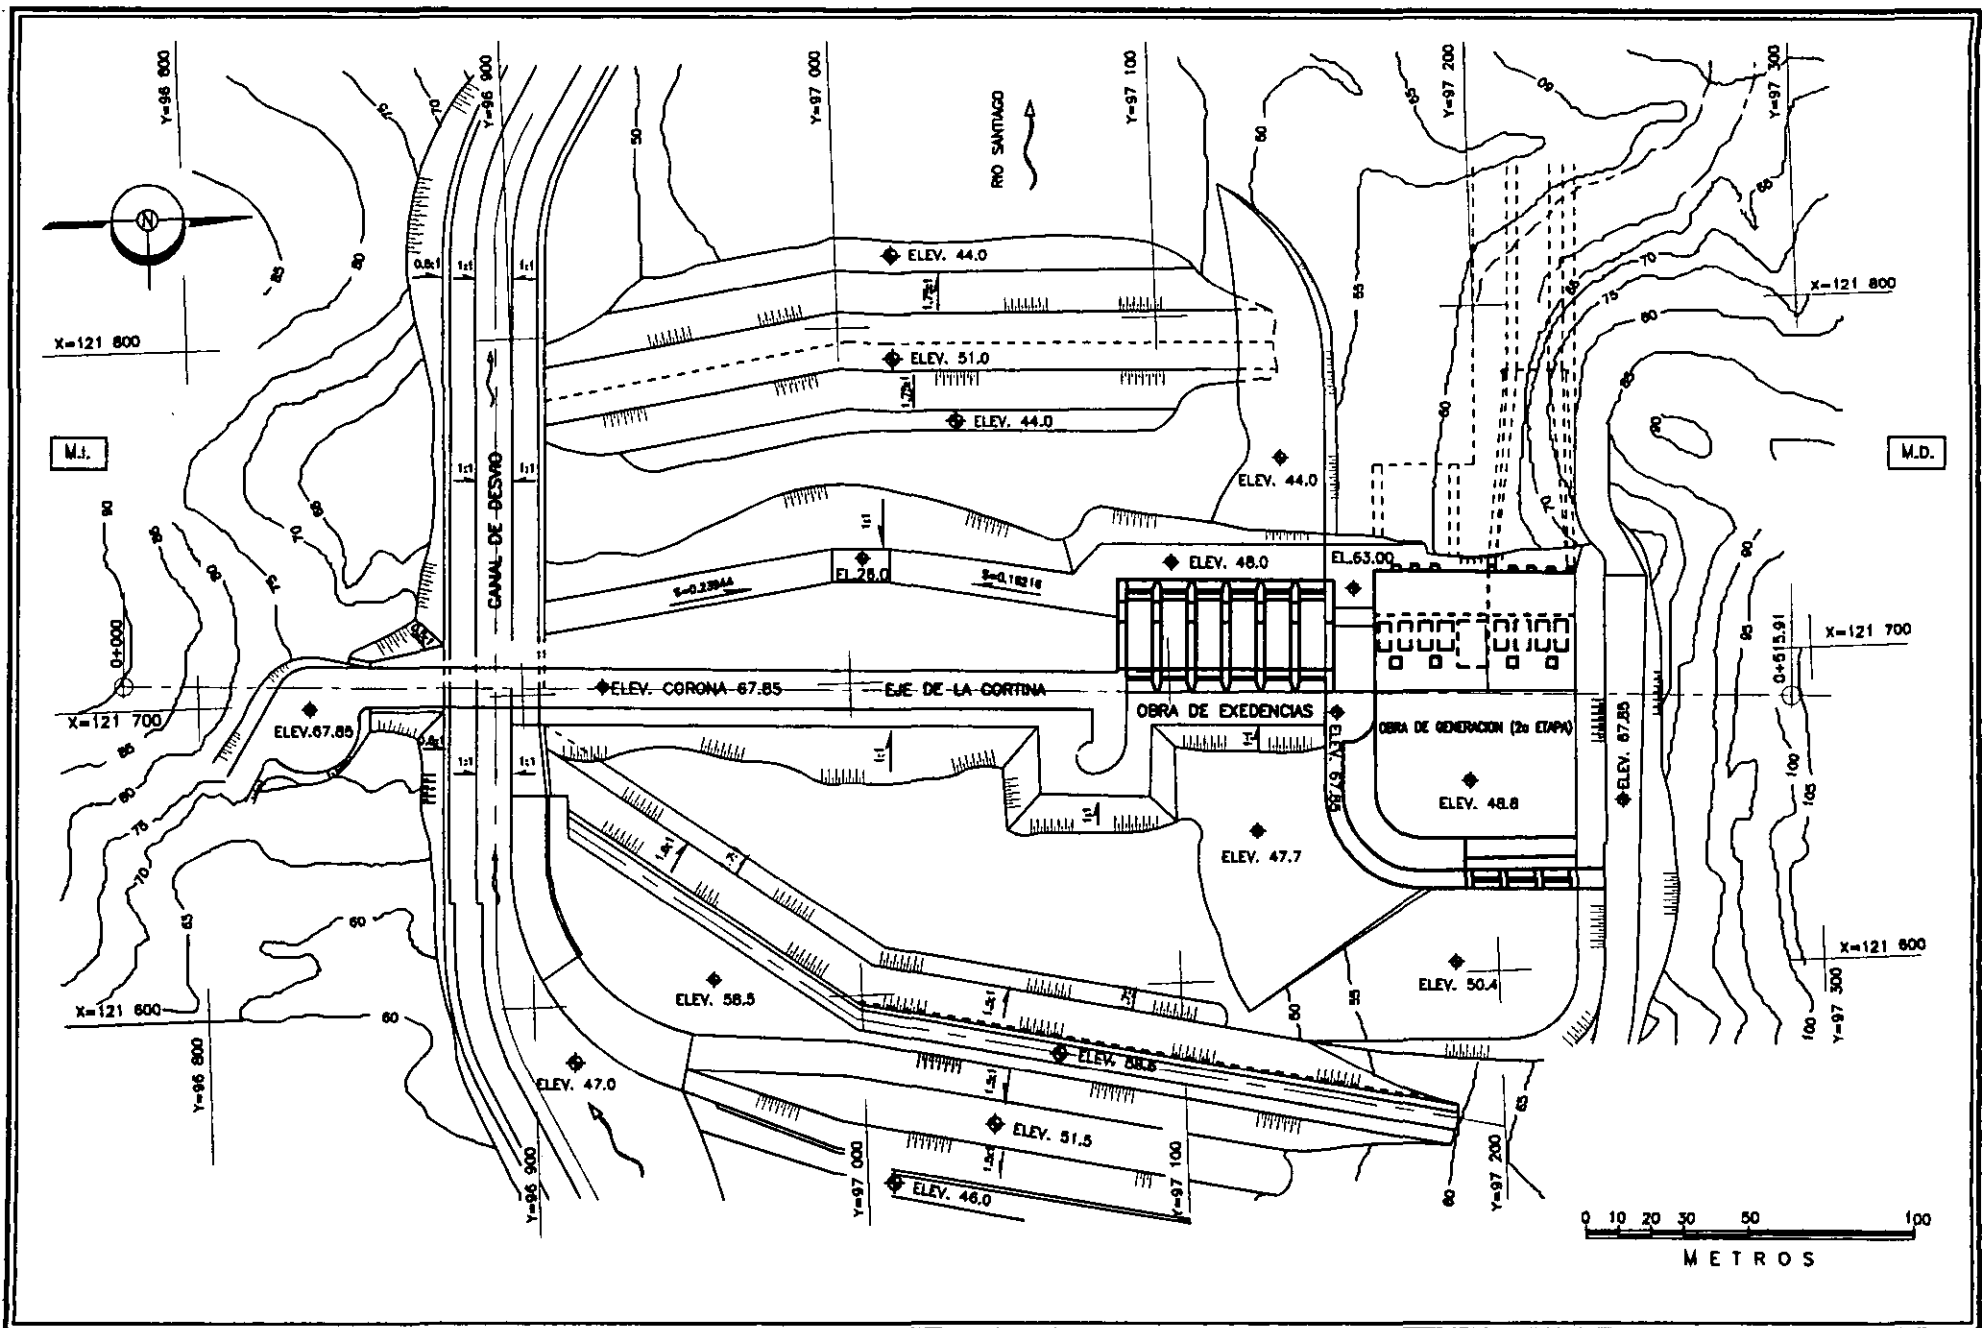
Planta general de la P.R.H San Rafael. Nay.
